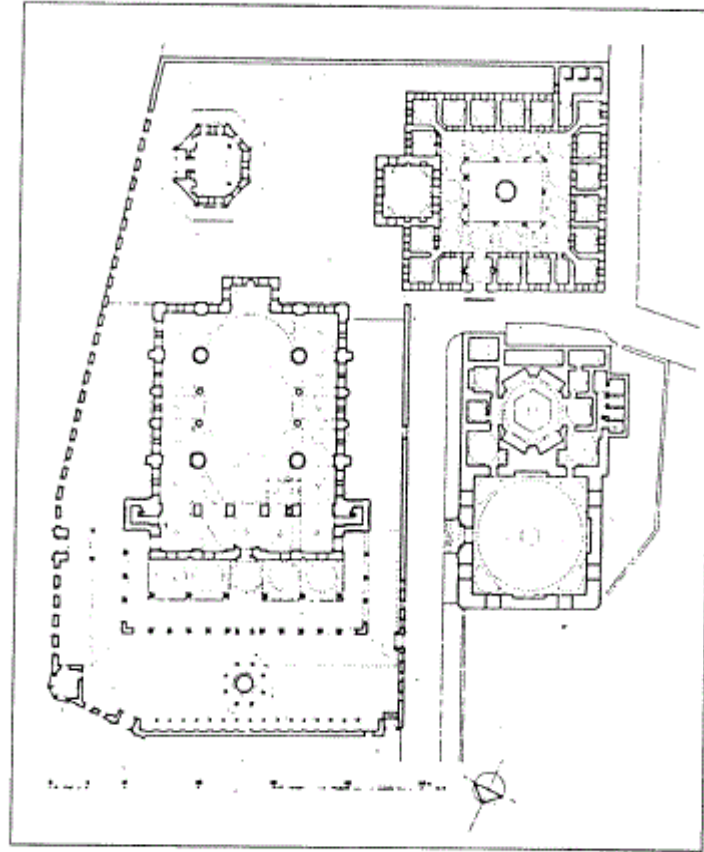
مسقط أفقي حمام محمود باشا بإستانبول (عن : جودوين) .
